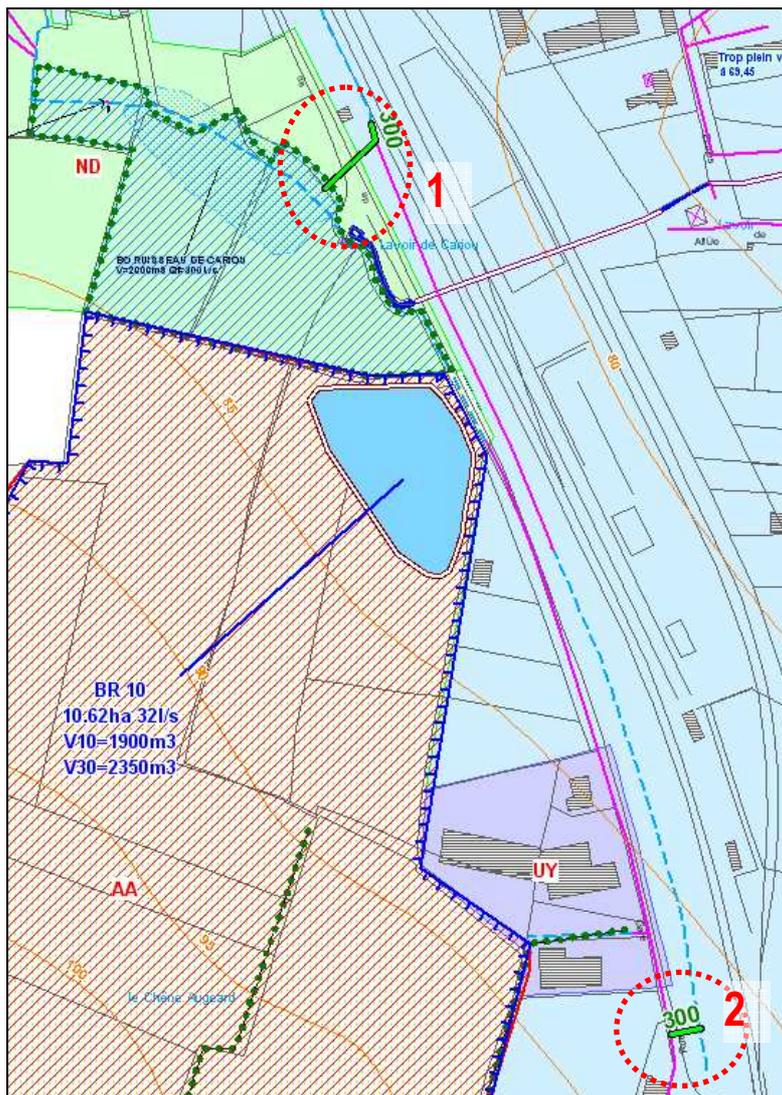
Plan du réseau pluvial – Rue de Cariou – Etat projet
